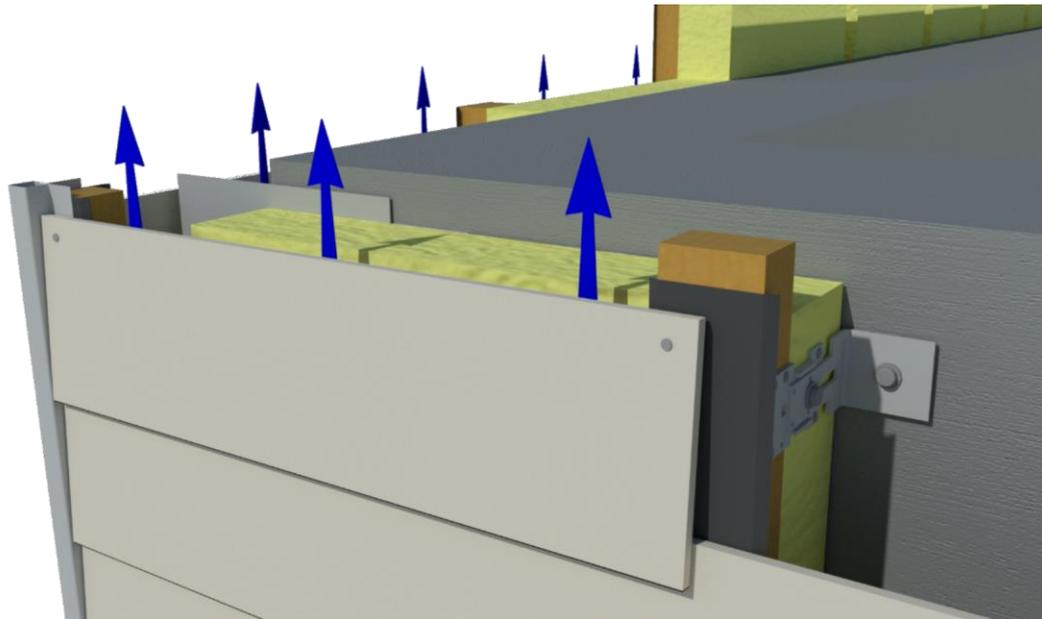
Pose horizontale des lames CEDRAL LAP avec isolant – fixation en rive haute
